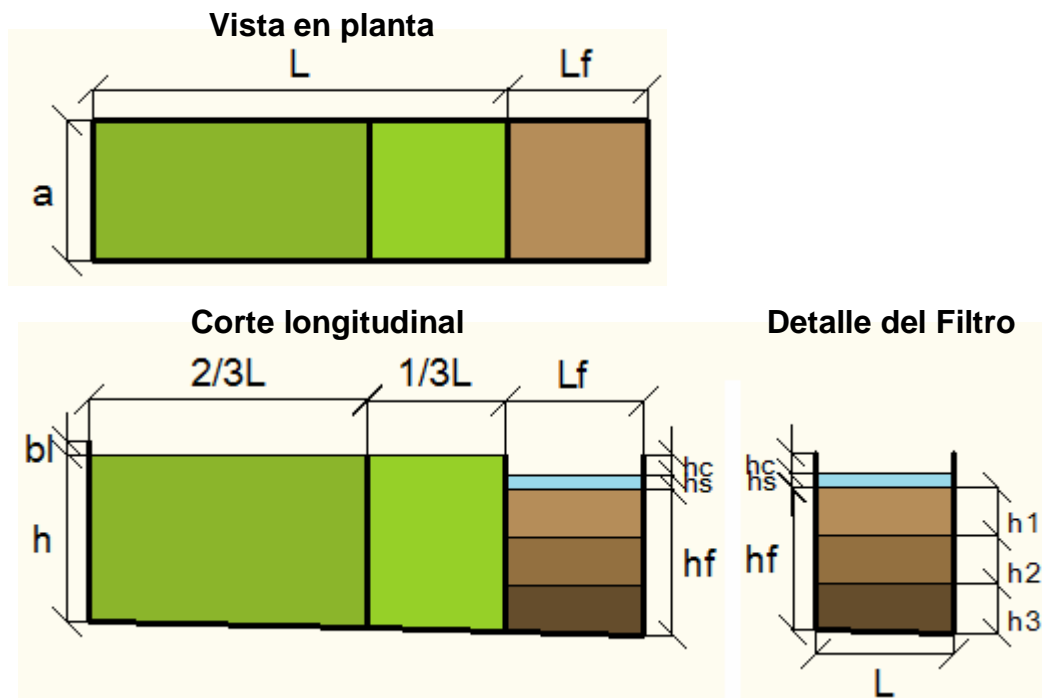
Esquemas vista planta, corte longitudinal y corte transversal del TSAM.
